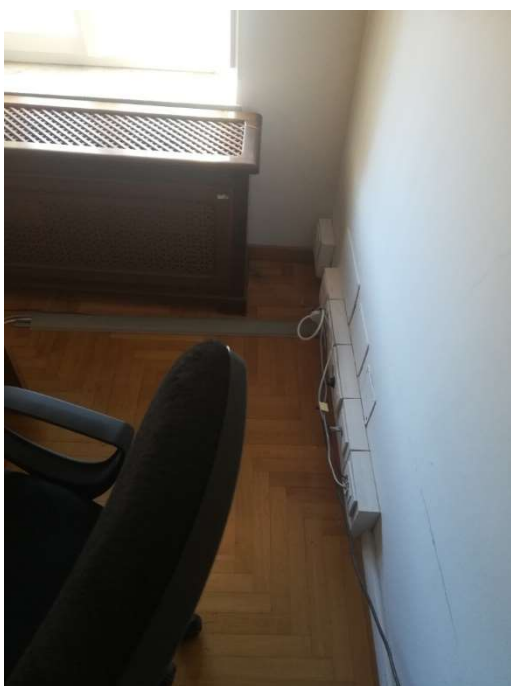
impianto elettrico fuori traccia piano terra Ambiente 2 e C5
